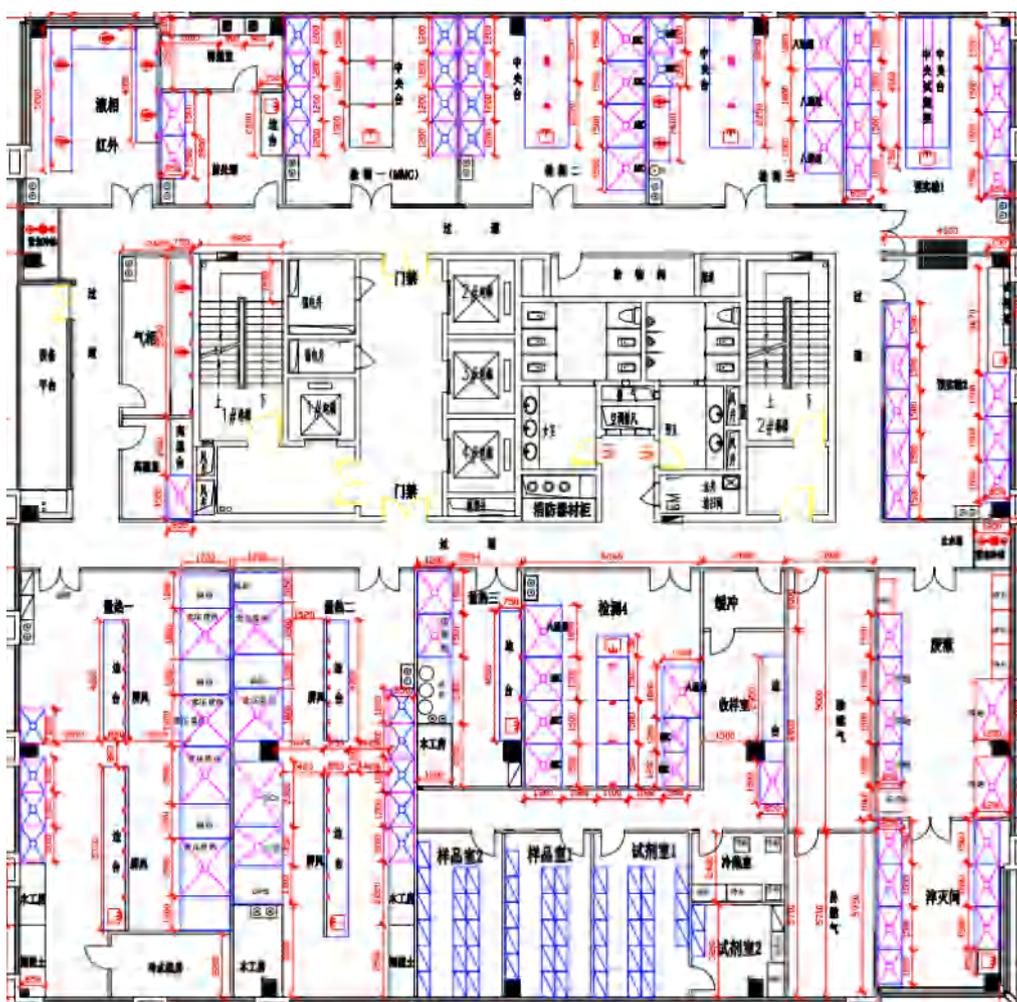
本项目 14 层平面布置图（详见附件 2.2）
